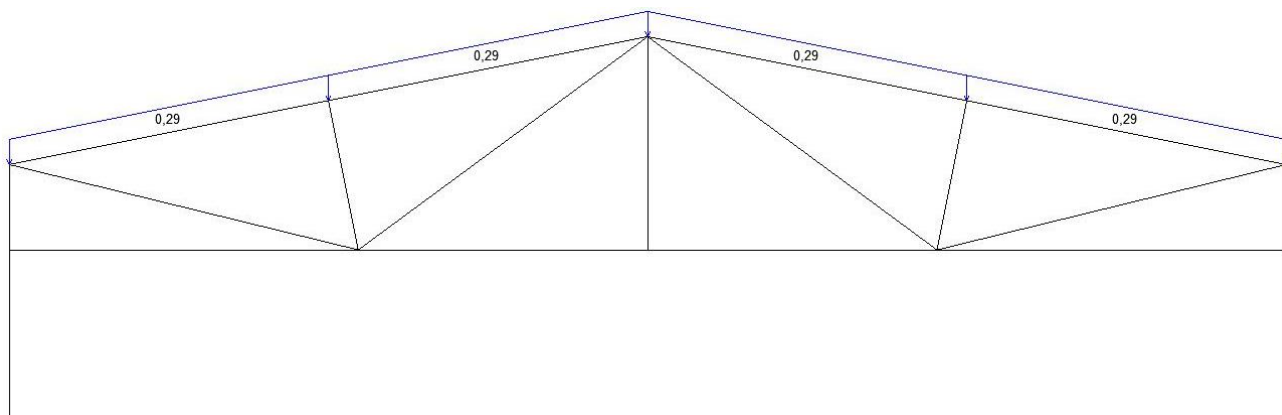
Нагрузка на ферму от веса покрытия и кровли
